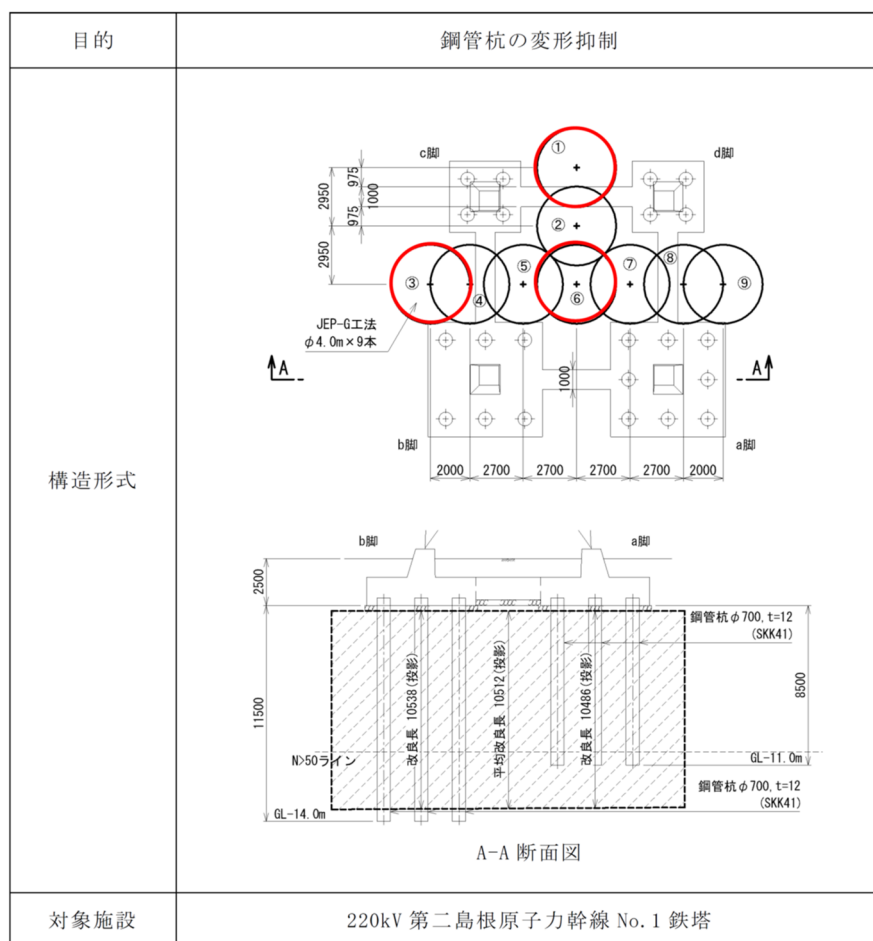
改良地盤の配置図 (図 2-1 A-A 断面)
